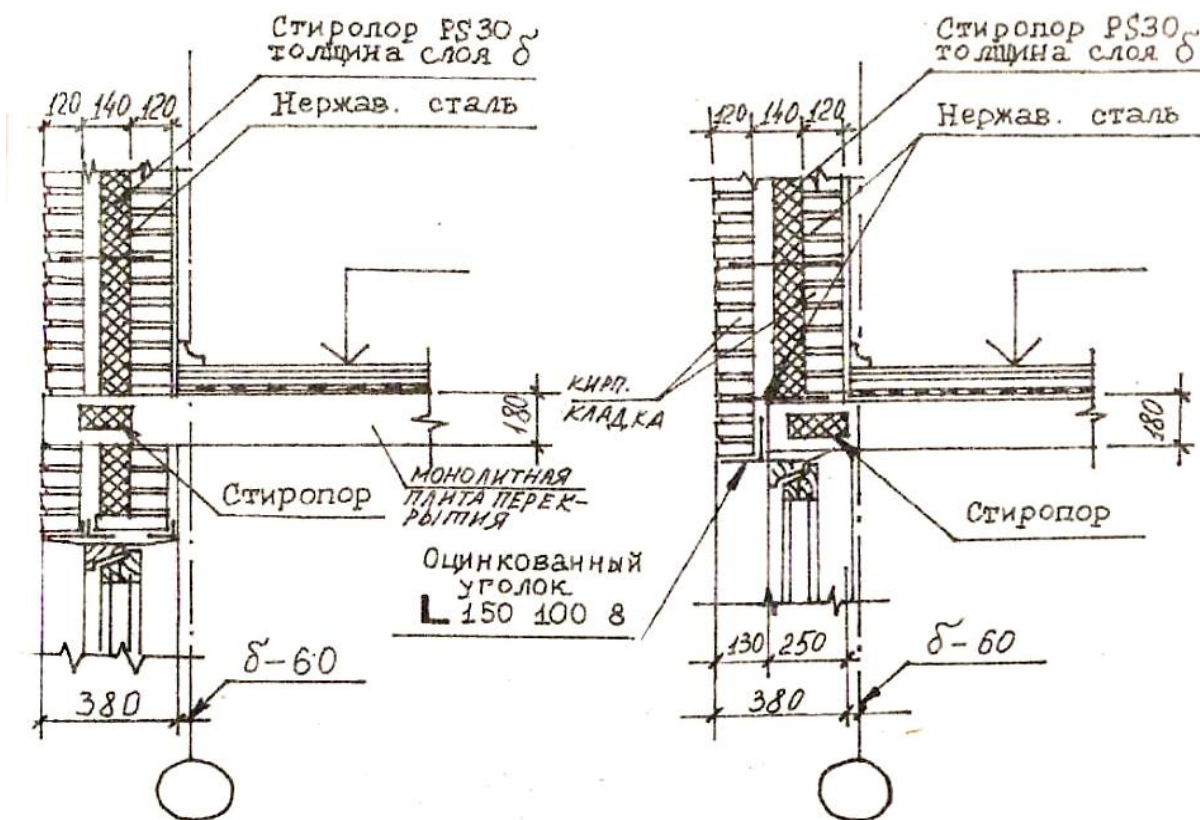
Детали опирания слоистых кирпичных стен на перекрытия каркасных зданий
